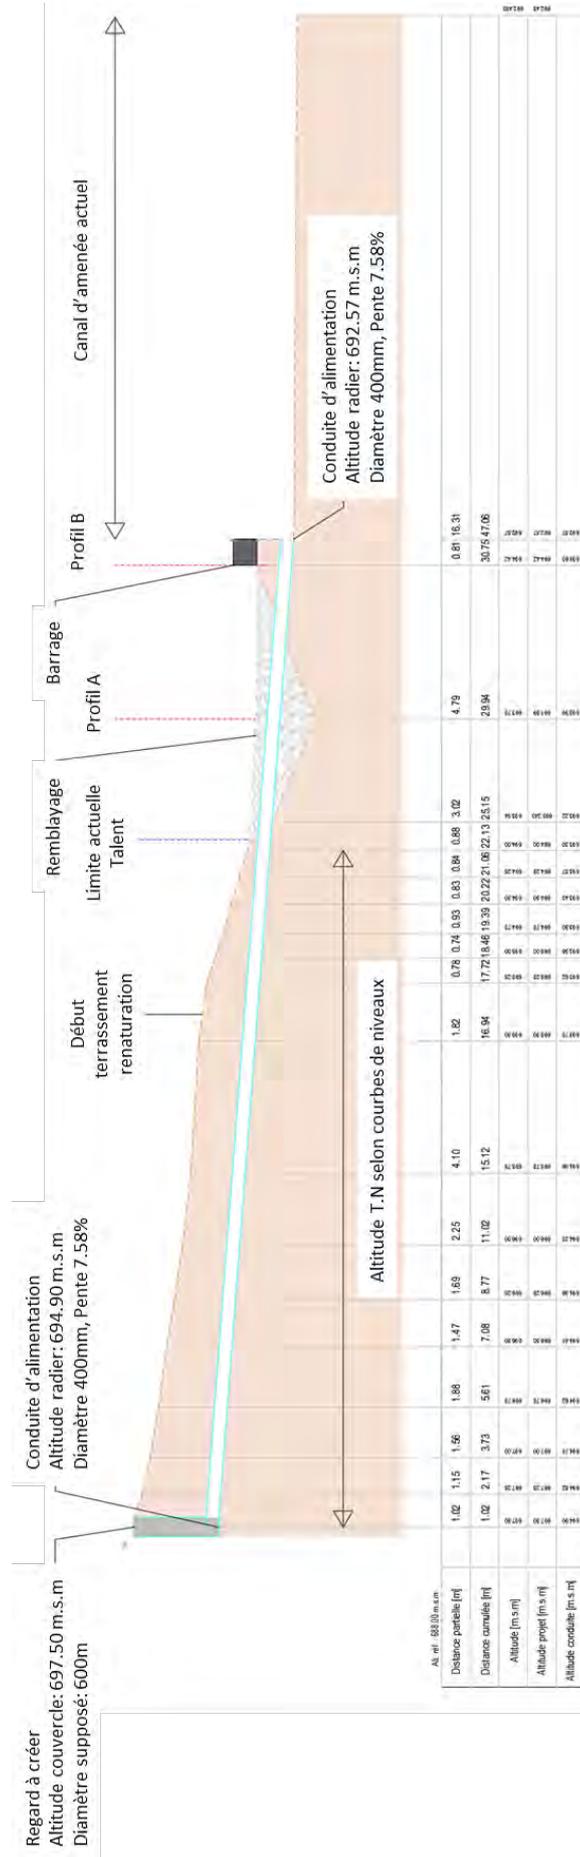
Profil en long de la conduite d'alimentation du canal d'amenée
